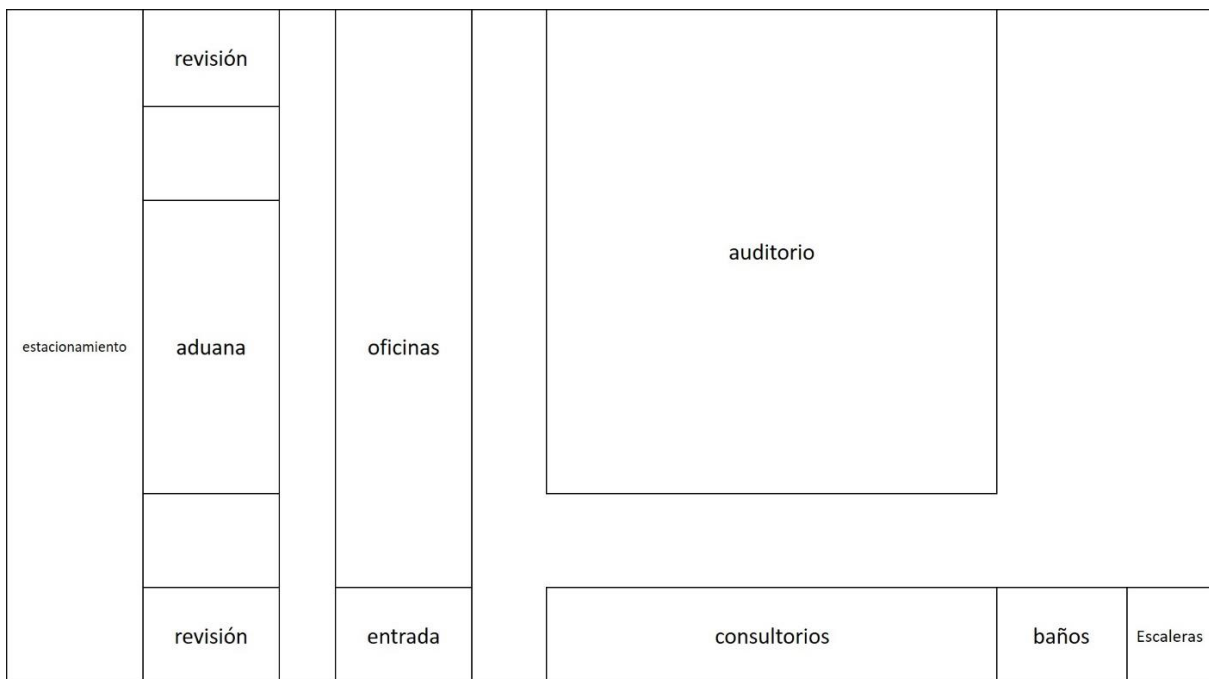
Croquis de la planta baja del Centro de Internamiento Juvenil.
